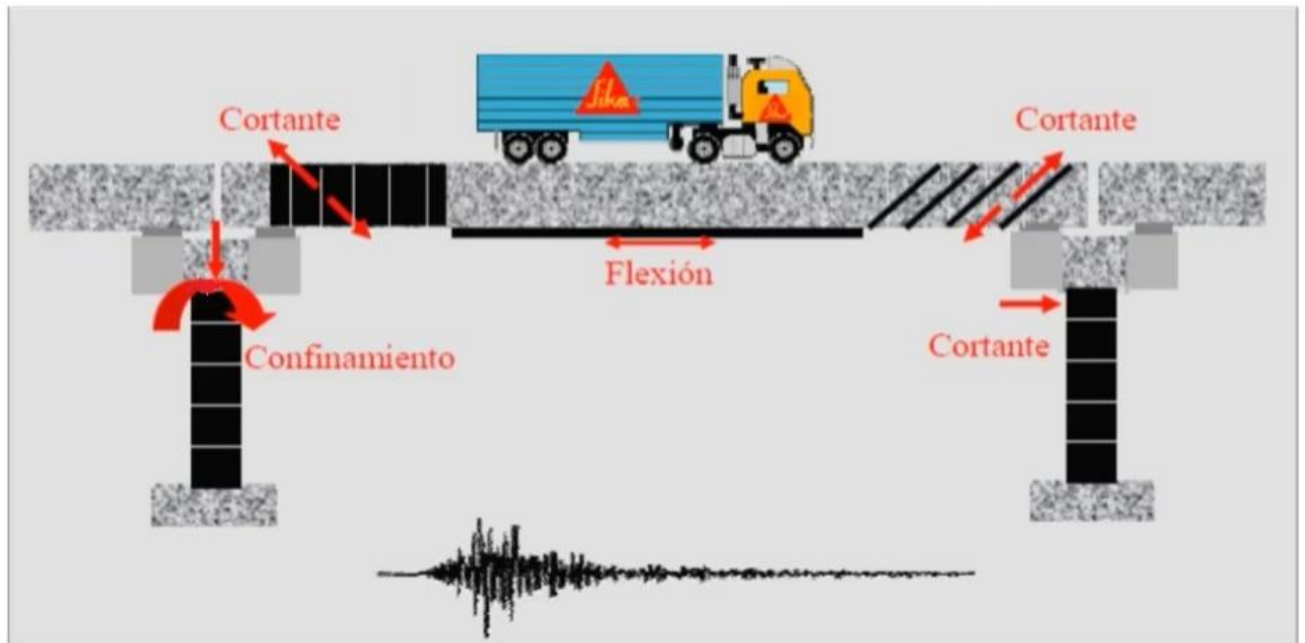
Esfuerzos en una estructura sometida a cargas.
